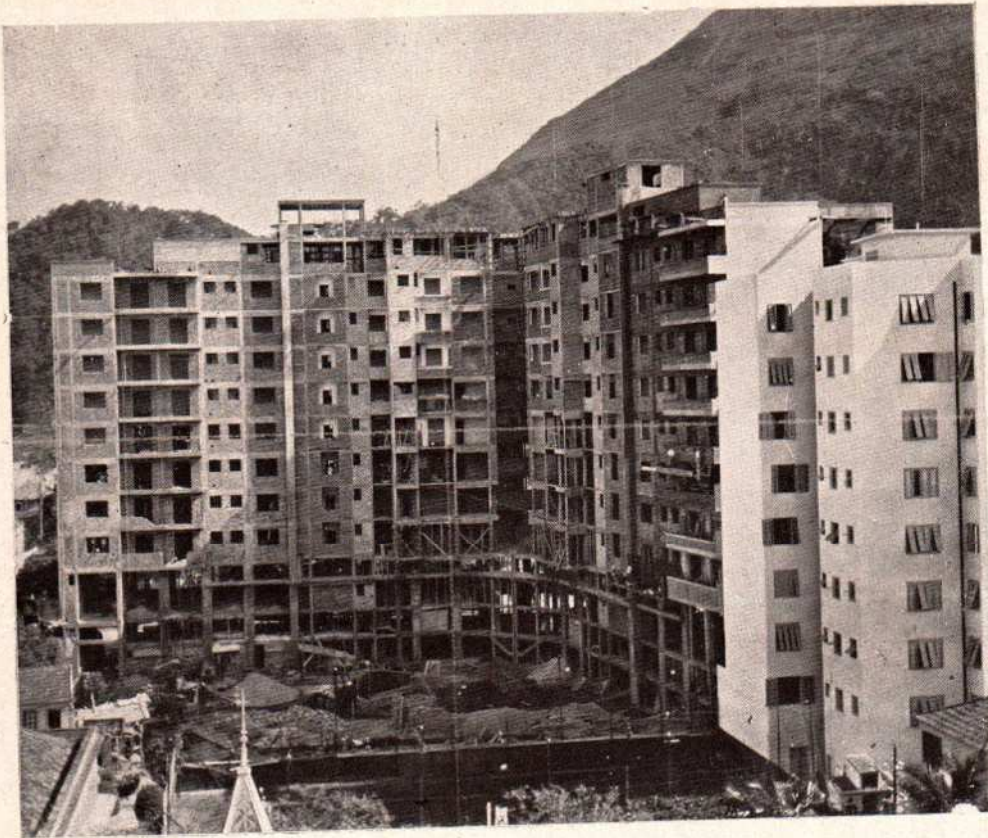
Fachadas posteriores do Edifício, vendo-se a area onde está localizado o Cinema.
